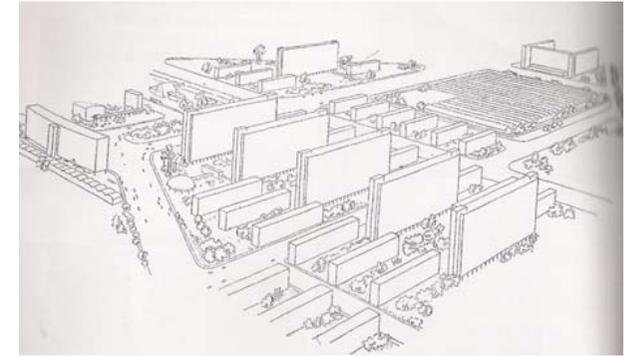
Conjunto residencial da baixada do Carmo. Arquiteto Attilio Correa Lima.
